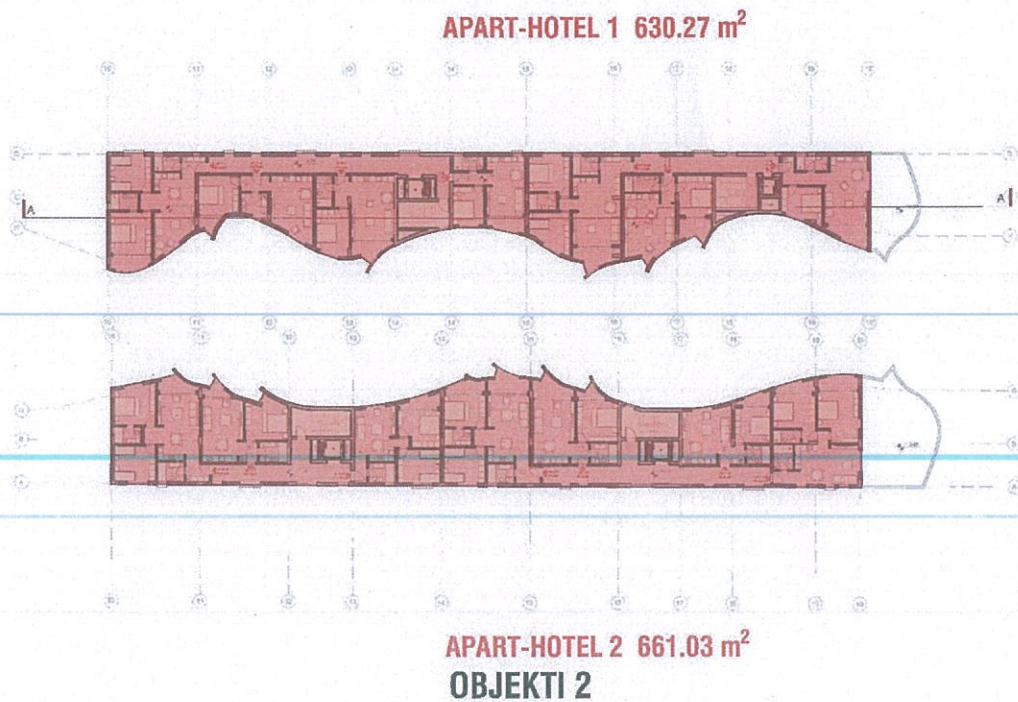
Planimetria e Katit të Katërt \_ APART - HOTEL
